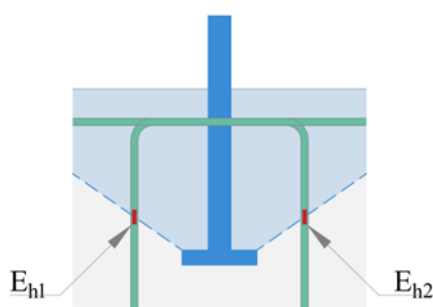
Posição dos extensômetros na armadura de suspensão.
